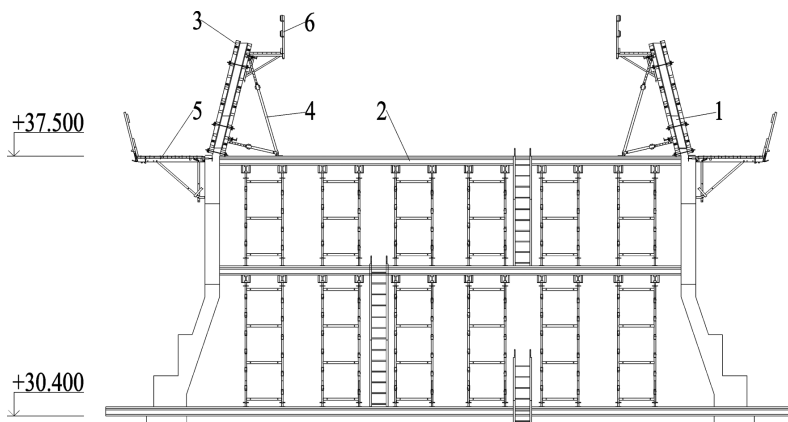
Схема опалубки наклонных стен шатра Храма:
